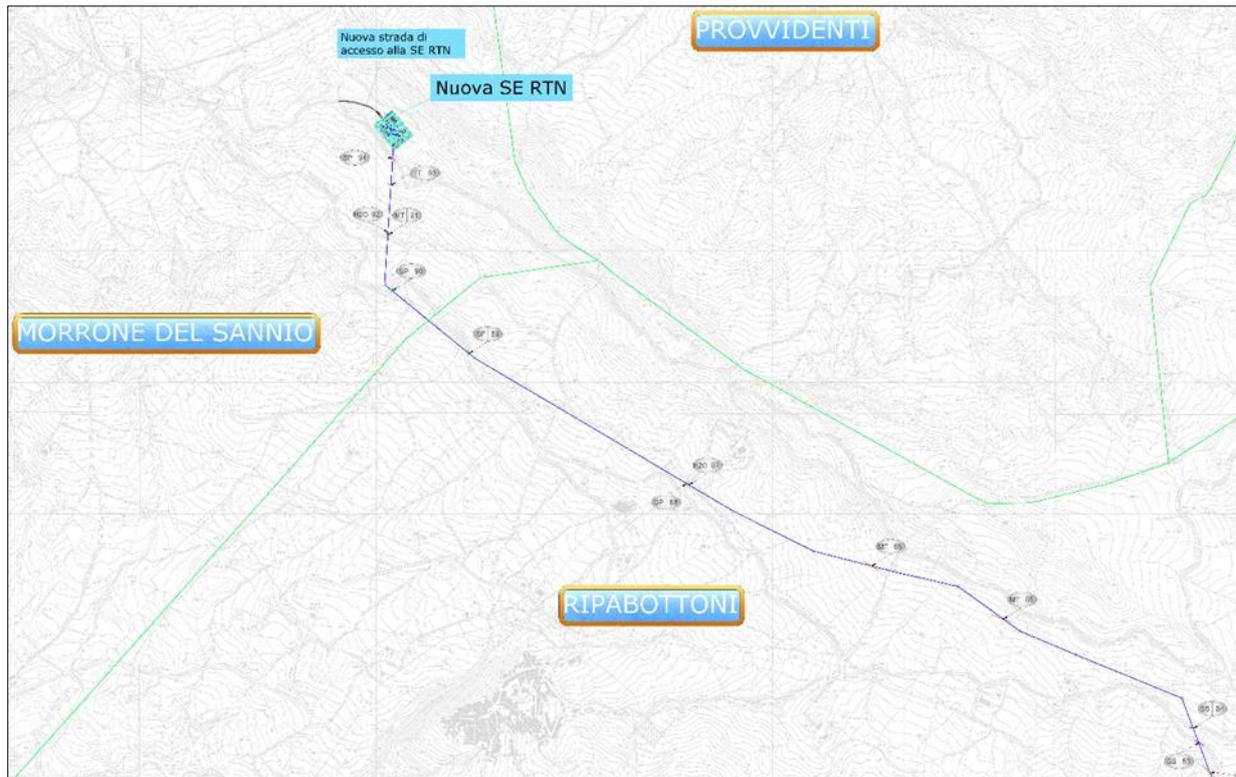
Stralcio planimetria tracciato elettrodotto su CTR (5/5)
